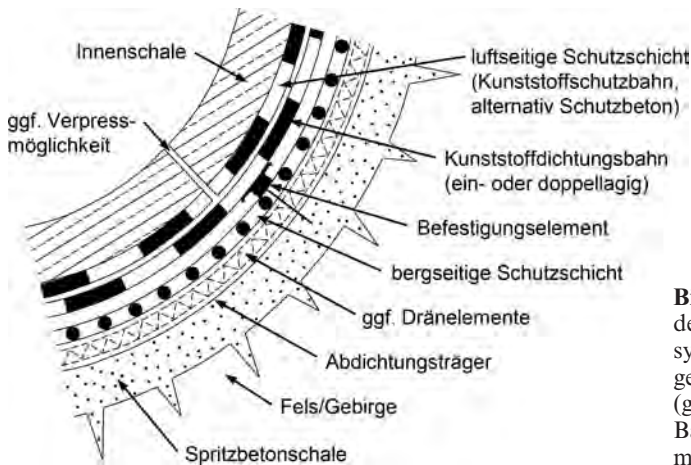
Aufbau des Dichtungssystems im Sohlgewölbe (geschlossene Bauweise, nicht maßstäblich).
